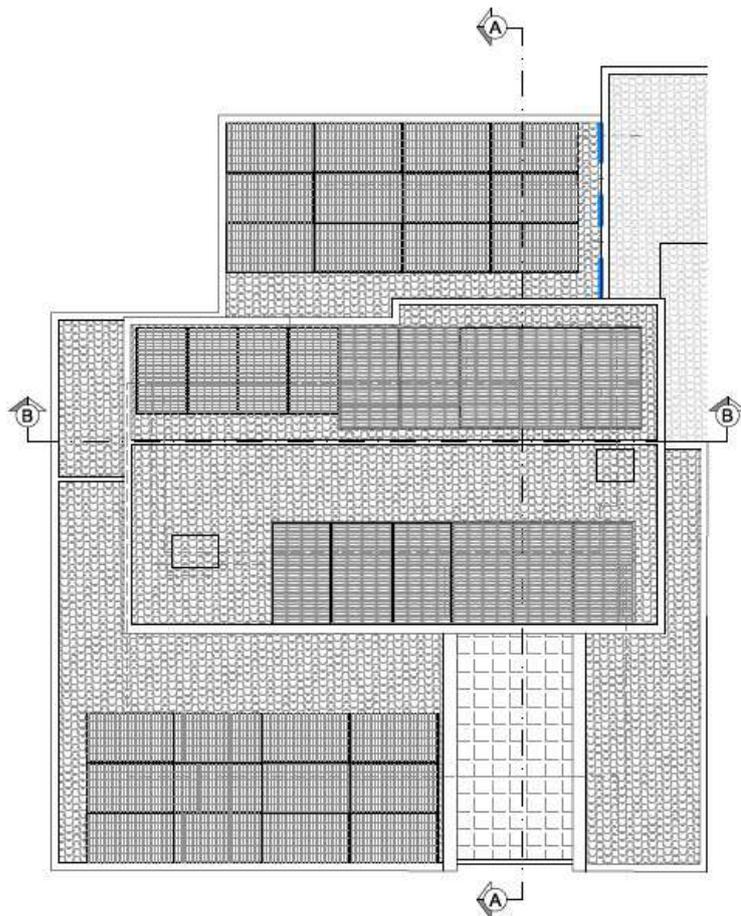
VARIANTE ALLA SCIA n°14755 del 13/12/2022 stralcio tavola di progetto in variante del piano copertura
